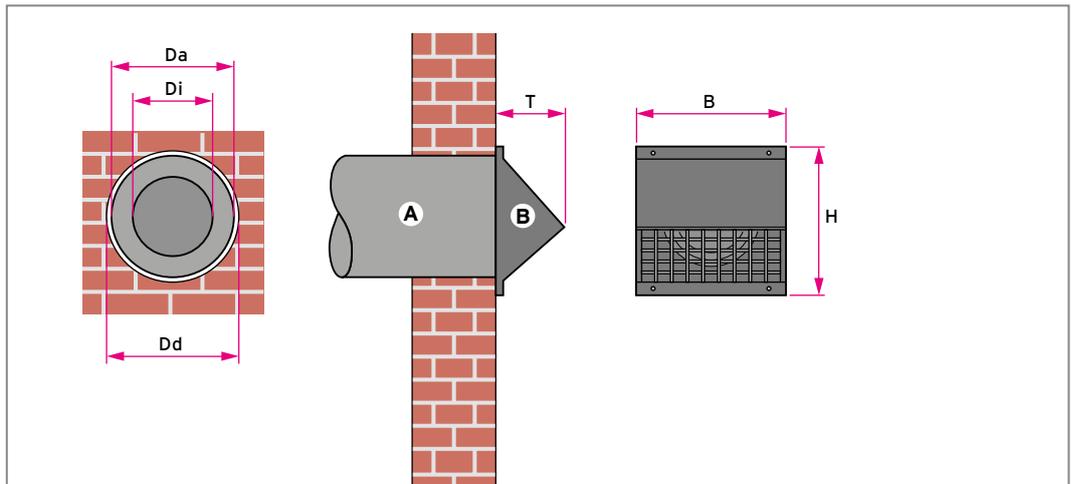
Fassadendurchführung mit dickwandigem EPP Rohr
